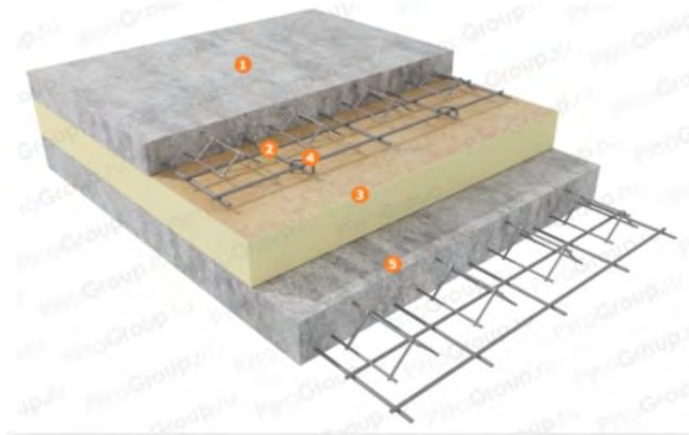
Розріз тришарової залізобетонної панелі (1, 2 - зовнішній шар залізобетону, 3 - шар утеплювача, 4 - зв'язки залізобетону, 5 - внутрішній шар залізобетону)
